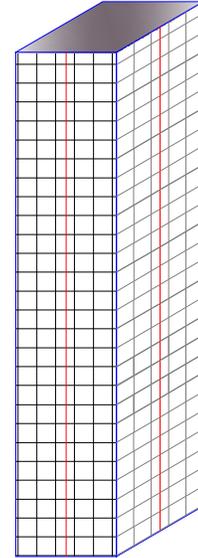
Ejemplo del sistema estructural tipo “tubo”
